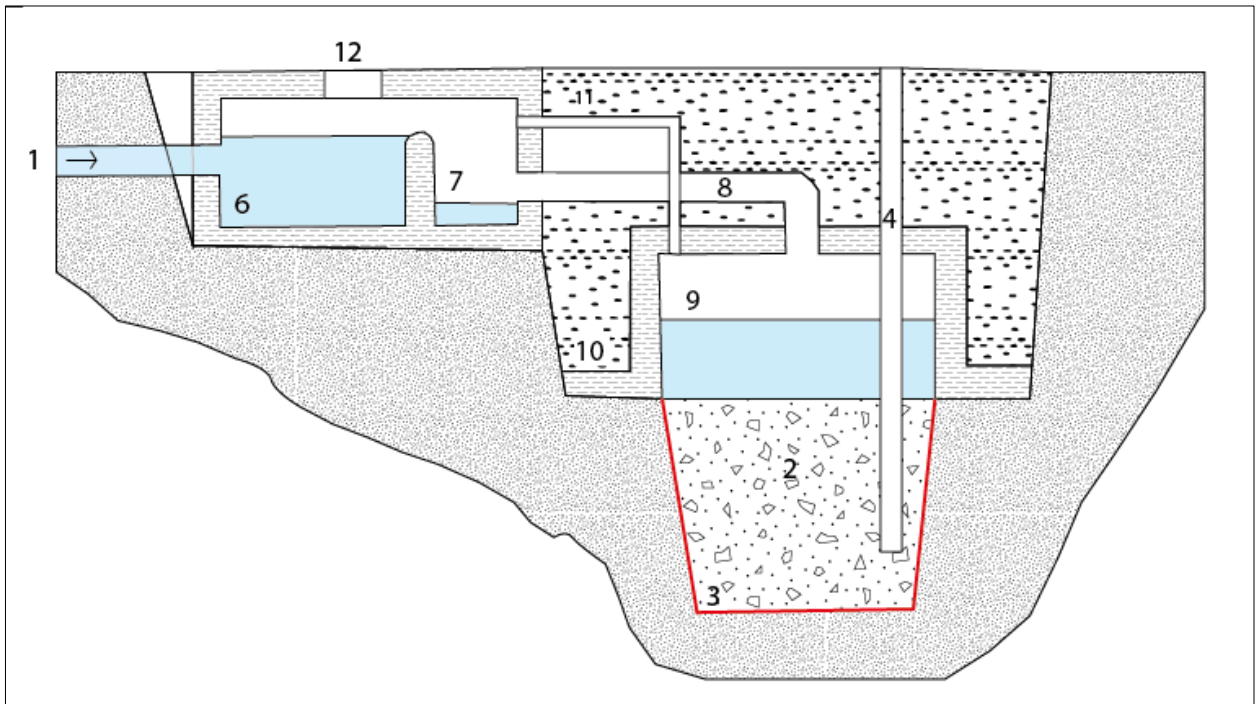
Pozo de infiltración con decantador y volumen parcial sin relleno. 1) Cubierta permeable, 2) Relleno, 3) Geotextil (línea roja), 4) Piezómetro, 5) Almacenamiento superficial 6) Decantador, 7) Cámara rebase, 8) Tubería alimentación, 9) Volumen sin relleno, 10) Antepozo de hormigón armado, 11) Tubo ventilación, 12) Tapa cámara. Fuente: modificado de MINVU, 1996.
